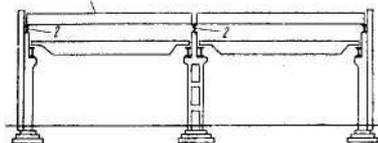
Одноэтажные промышленные здания с плоским покрытием
